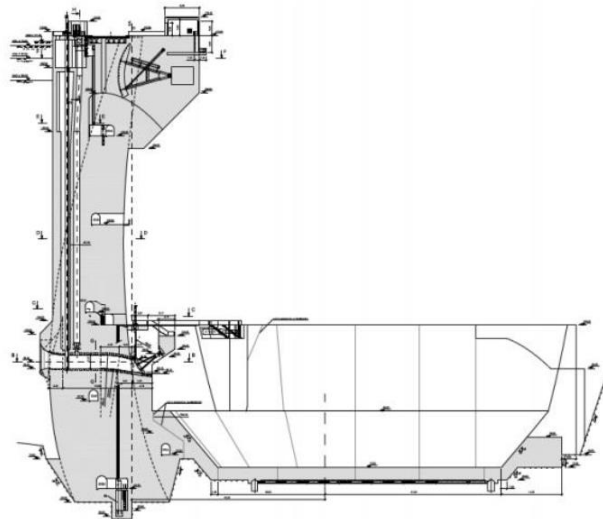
Perfil longitudinal da descarga de fundo (Carvalho, 2013)
